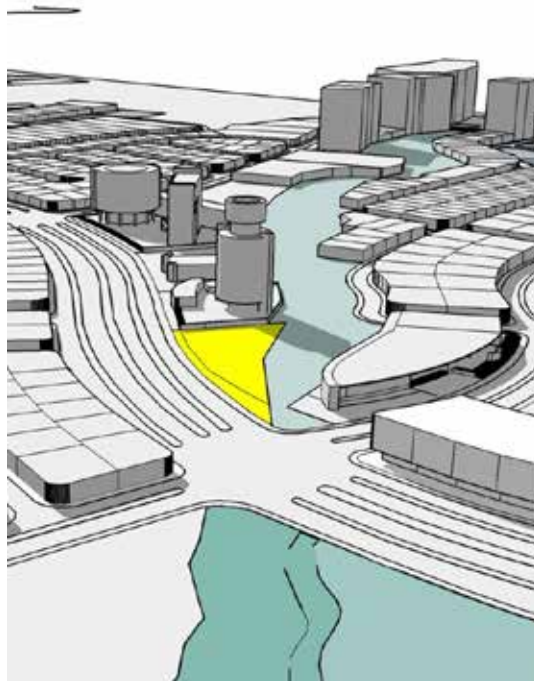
Plano conjunto esquemático del concepto (2018)
